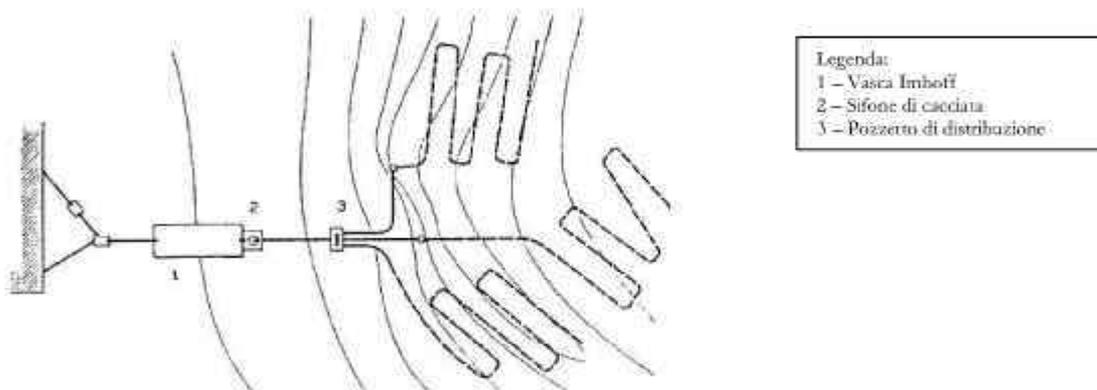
Andamento planimetrico delle condotte di sub-irrigazione
